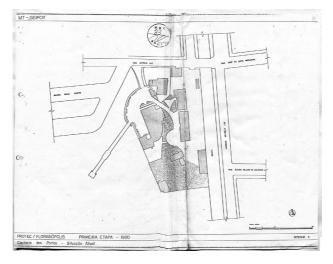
Planta de situação do Forte Santa Bárbara. Fonte: Arquivo Noronha Santos (RJ).
